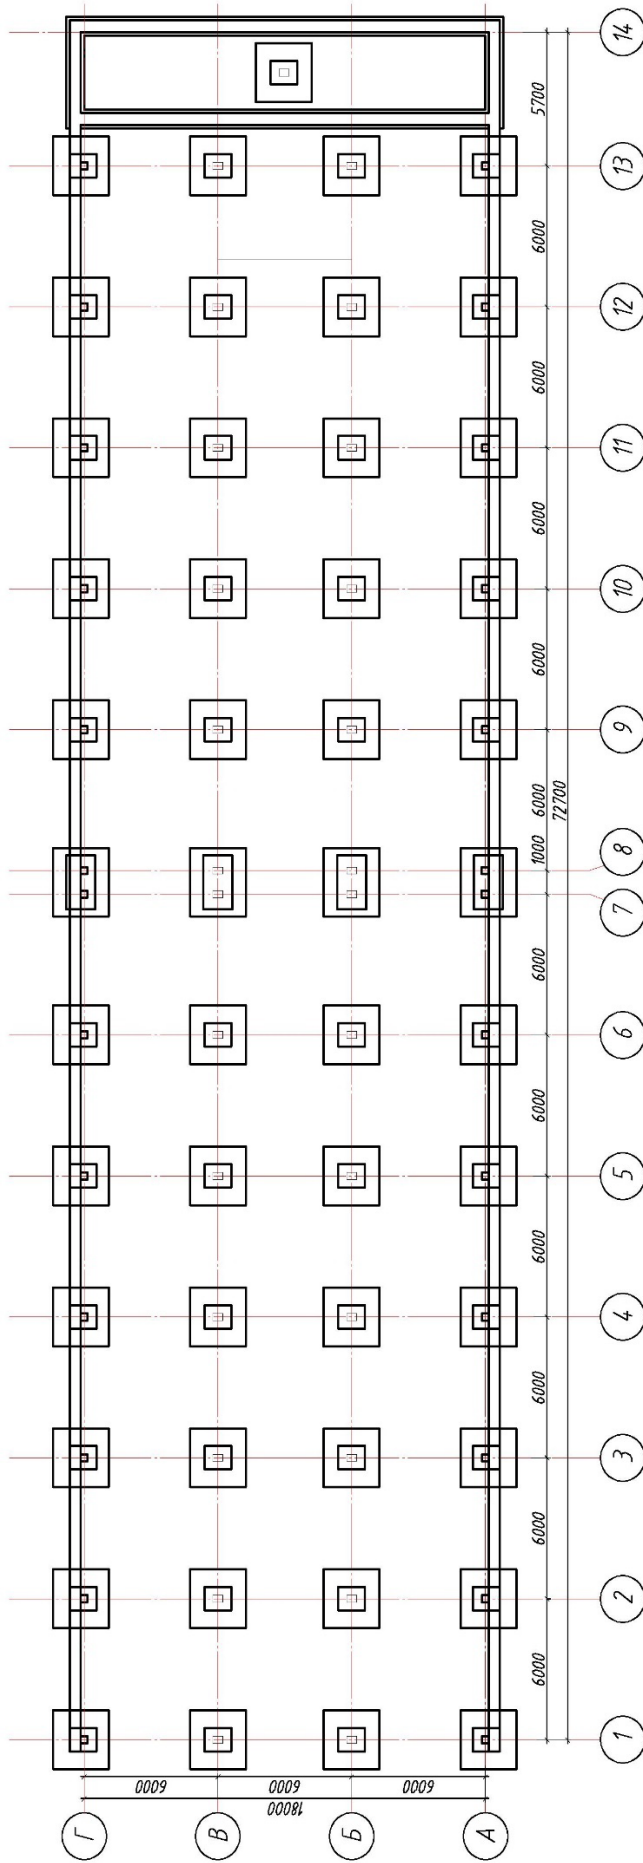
План фундаментов обследуемого здания клиники №5
